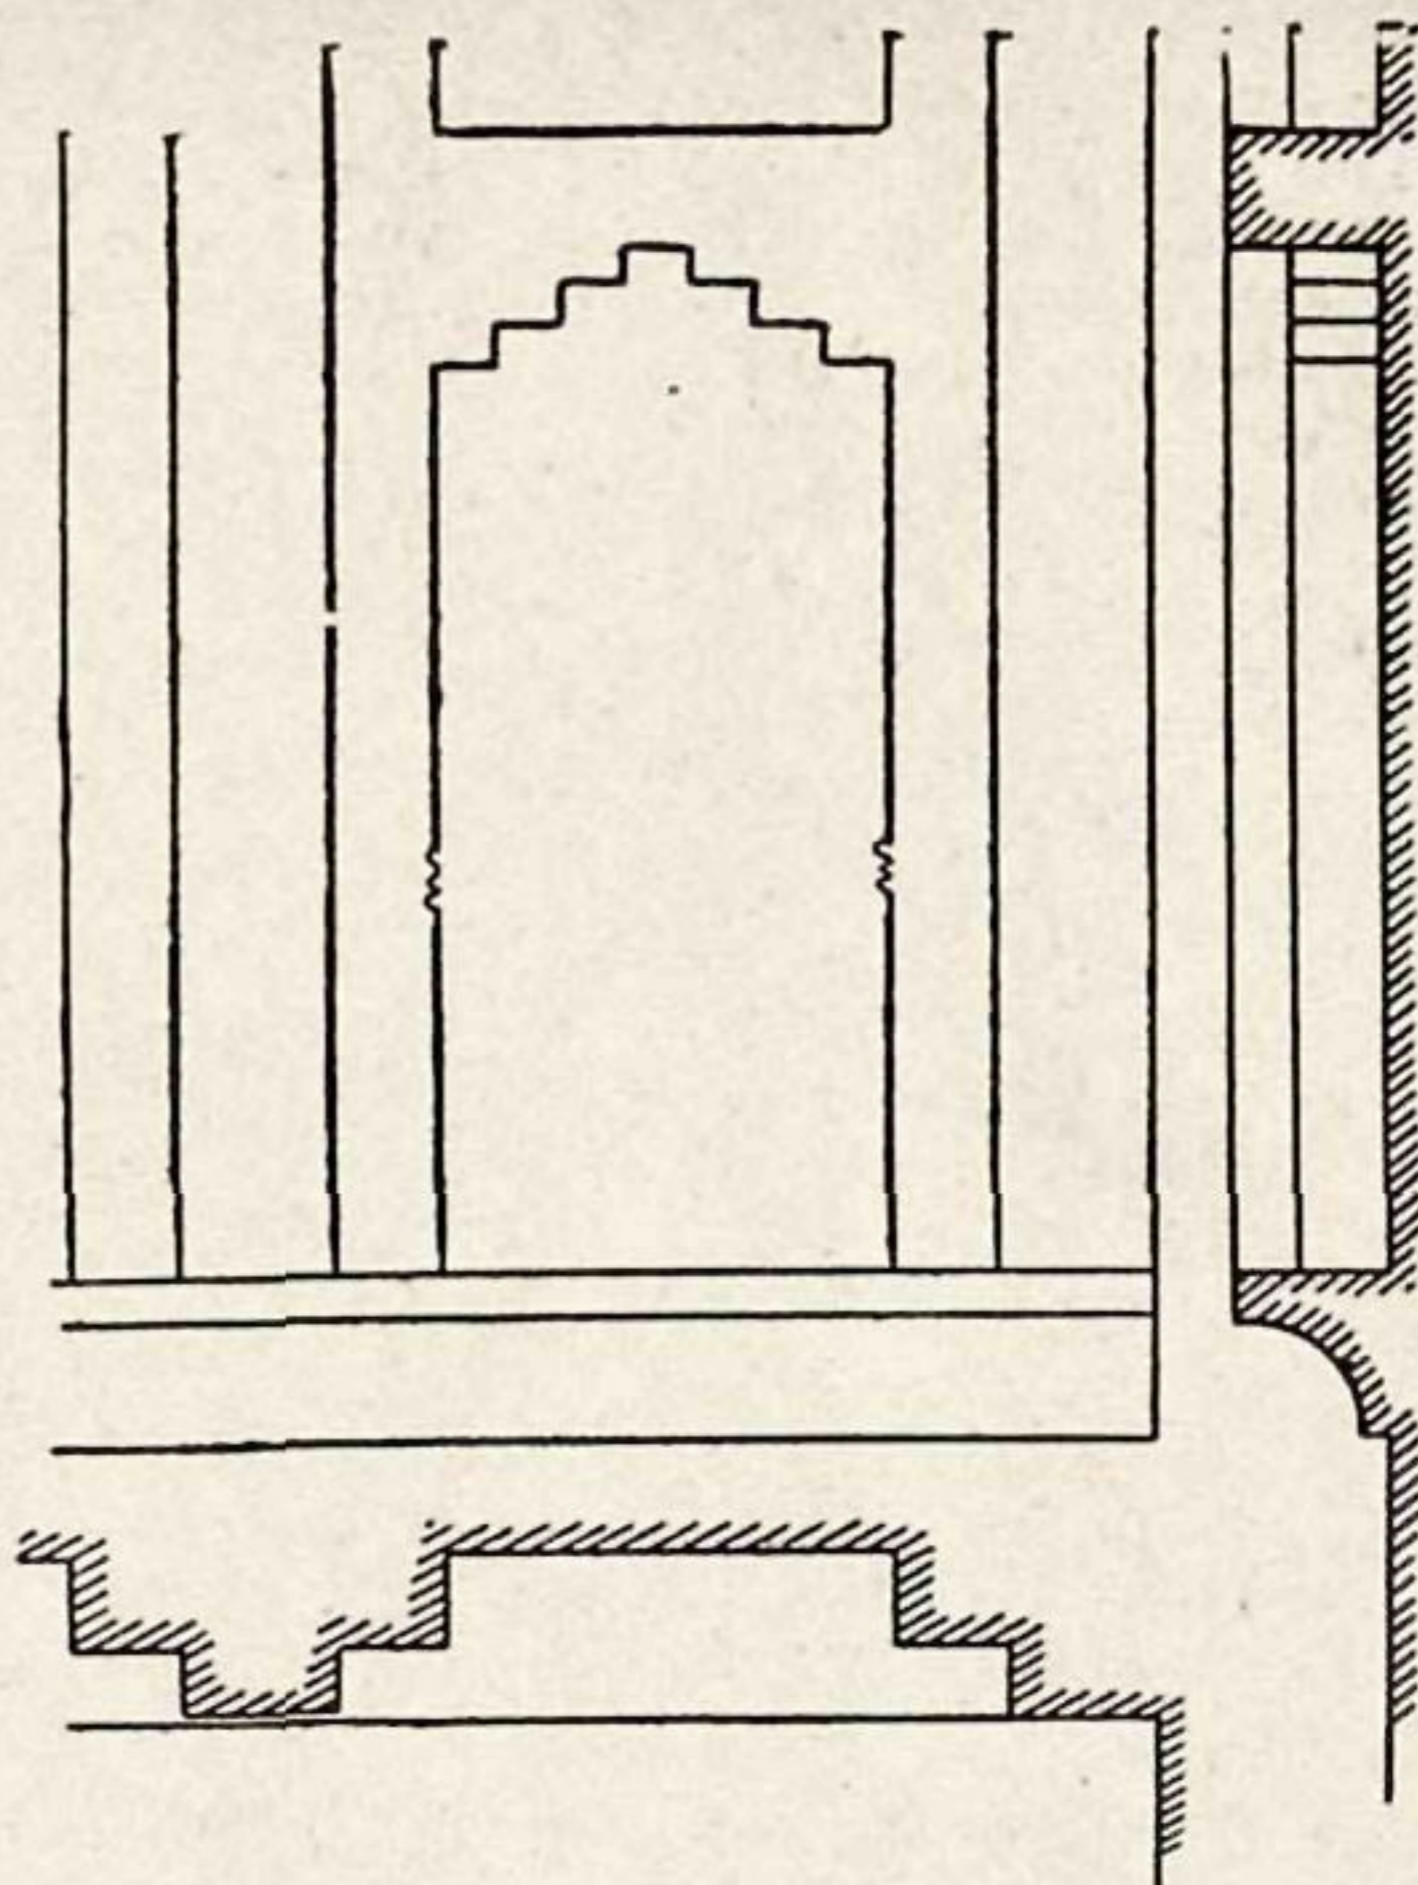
Профиль, план и фас кладки в щипцовой стене помещения В в здании № 13.
